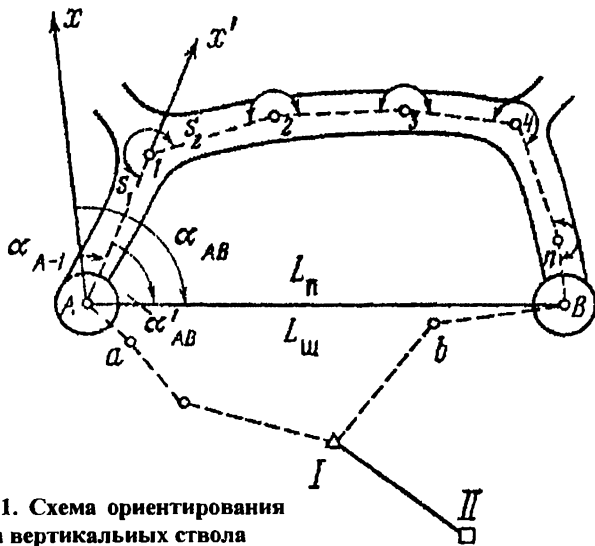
Схема ориентирования через два вертикальных ствола
